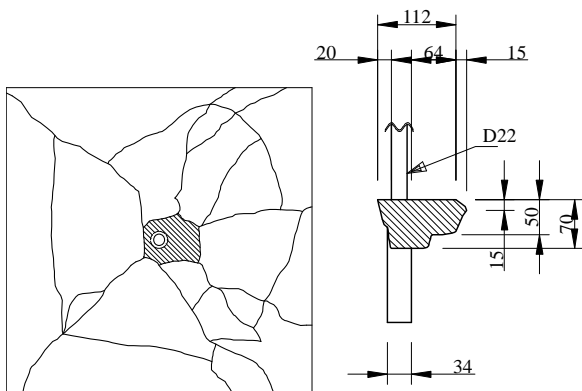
ひび割れ観察結果 (供試体 8N)
